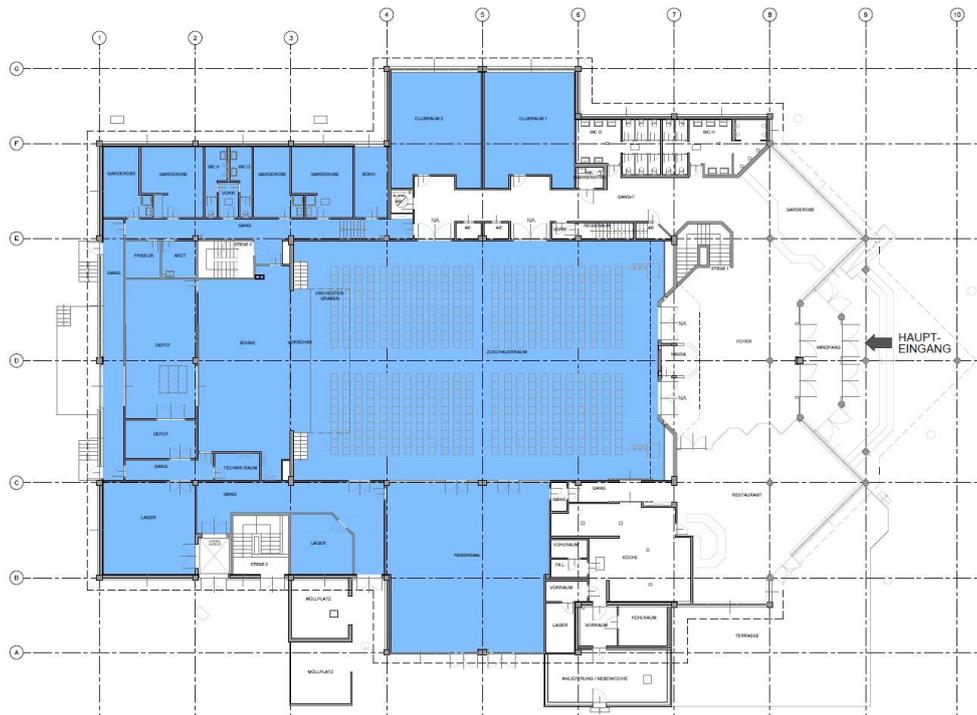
Übersichtsplan Erdgeschoss – Veranstaltungsbereich
